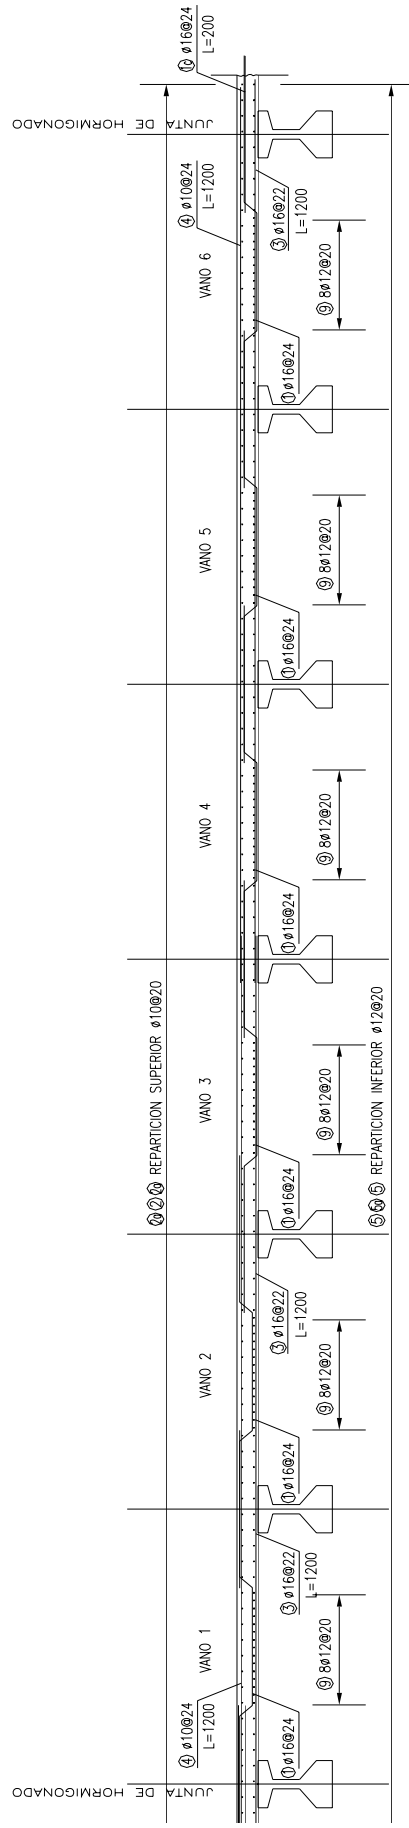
Armaduras Losa Diseño Original. Sección Paralela Eje Autopista
